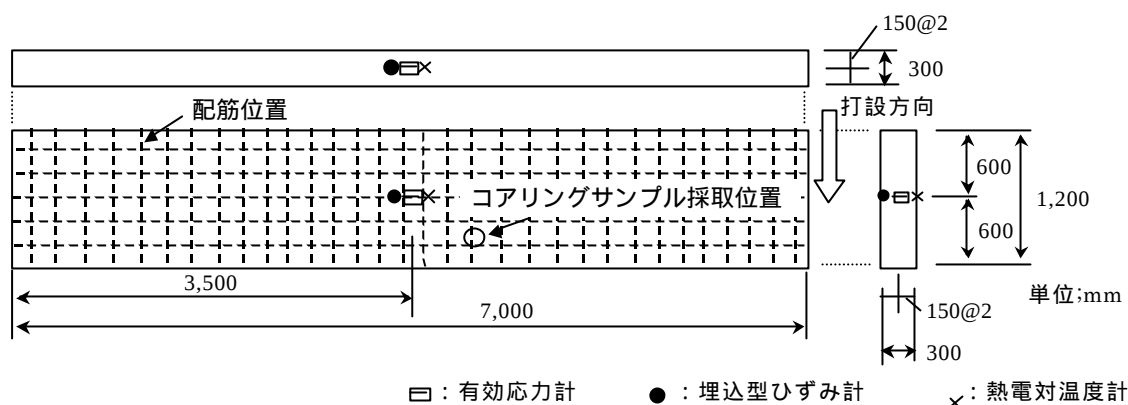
コンクリート壁体の寸法および計測機器設置位置
